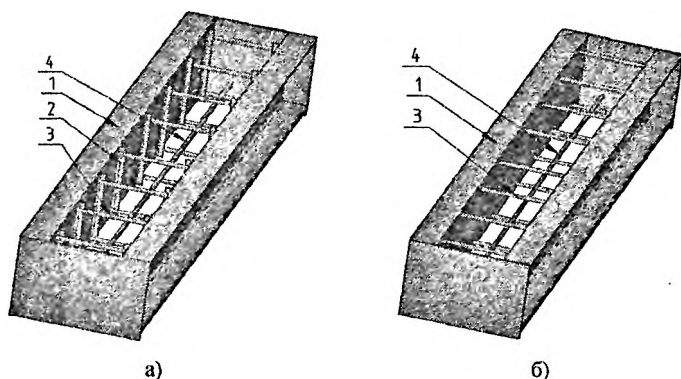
Конструктивное решение опытных балок типов I (а) и III (б) до бетонирования: 1 – внешнее жесткое армирование; 2 – анкерные устройства из равнонопочных уголков; 3 – анкерные устройства из арматурных стержней; 4 – армирование железобетонного ядра
